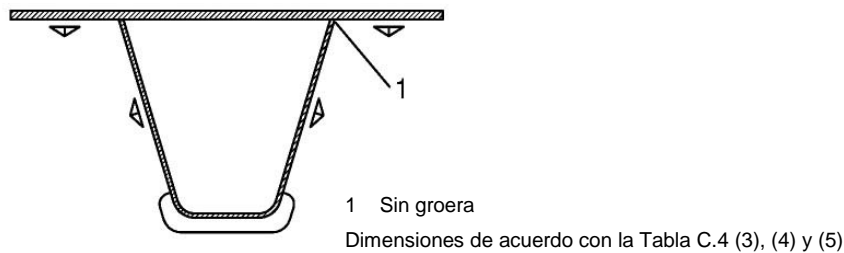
C.12 Uniones soldadas de los rigidizadores de sección cerrada con el alma de la viga transversal con groeras
